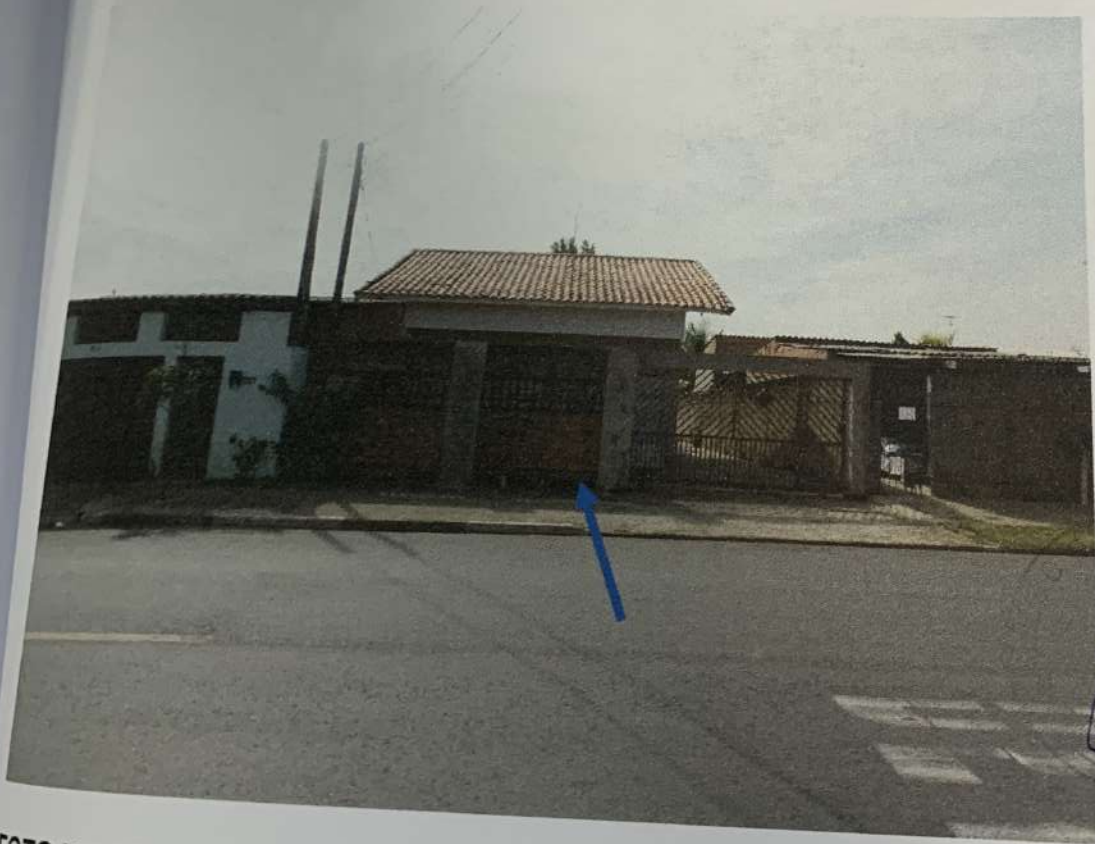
Vista da fachada frontal do imóvel avaliando.
